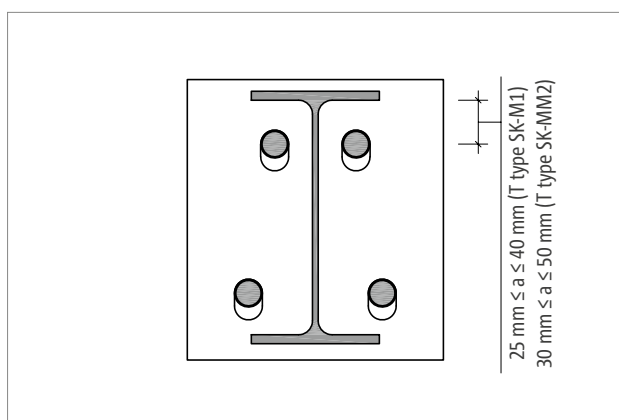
Schöck Isokorb® T type SK-MM2...-H200 : connexion de la plaque frontale au support IPE220
